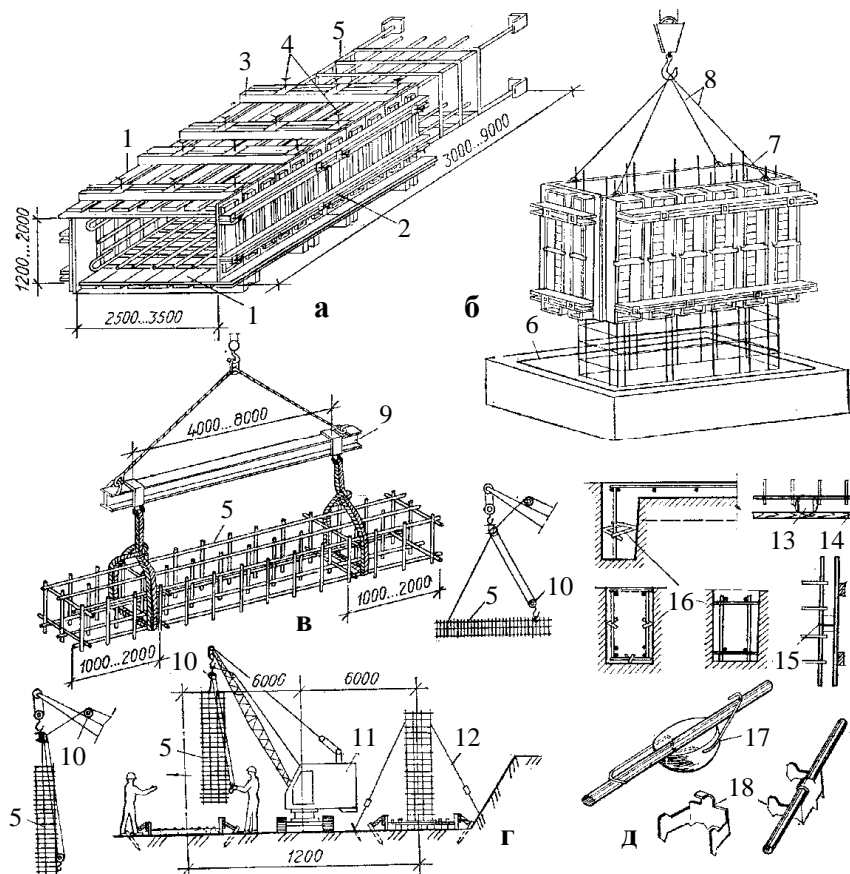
Схеми монтажу арматурно-опалубних і арматурних блоків: а – загальний вигляд арматурно-опалубного блока підколонника; б – монтаж блока; в – монтаж арматурного блока стрічкового фундаменту; г – монтаж арматурного блоку колони; д – підкладки для утворення захисного шару; 1 – щити опалубки; 2, 3 – схватки; 4 – кріпильні болти; 5 – блок арматури; 6 – стакан фундаменту; 7 – арматурно-опалубний блок; 8 – стропи; 9 – траверса; 10 – напівавтоматичний строп; 11 – гусеничний кран; 12 – розчалювання; 13 – підкладка; 14 – опалубка; 15 – бетонна прокладка зі скобою; 16 – сталеві коротуни; 17 – бетонний корок з пружинними скобами; 18 – металеві штамповані підставки
